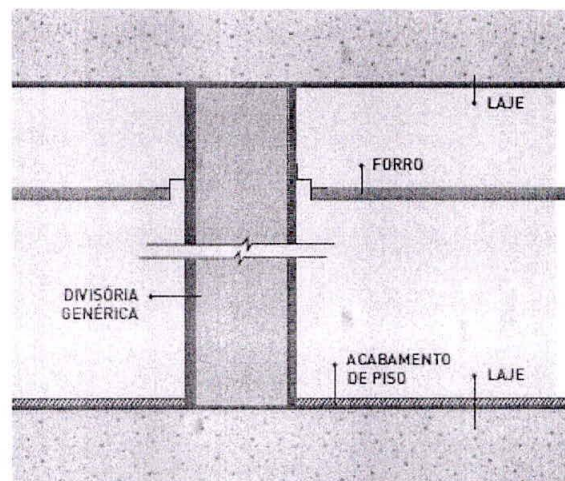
Exemplo Genérico da Divisória Laje a Laje
